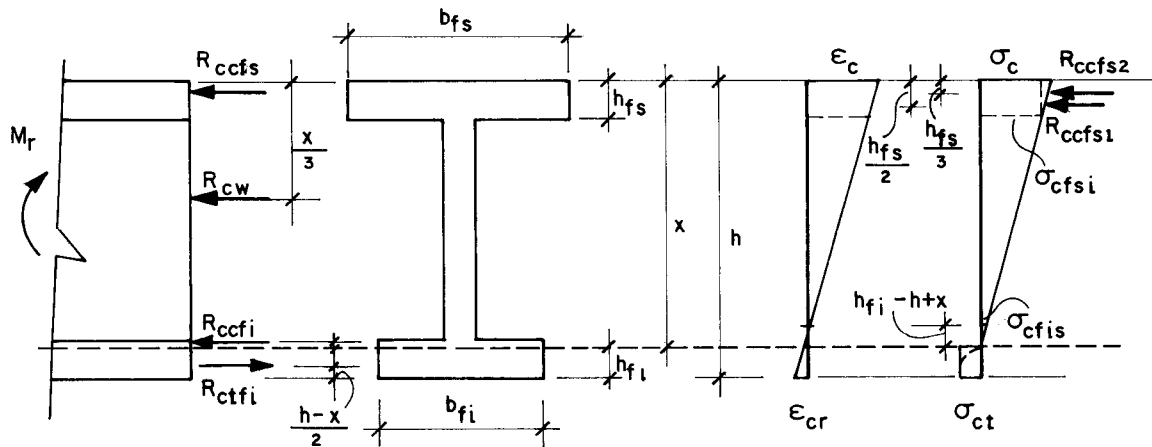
MOMENTO DE FISSURAÇÃO — LN NA MESA INFERIOR
